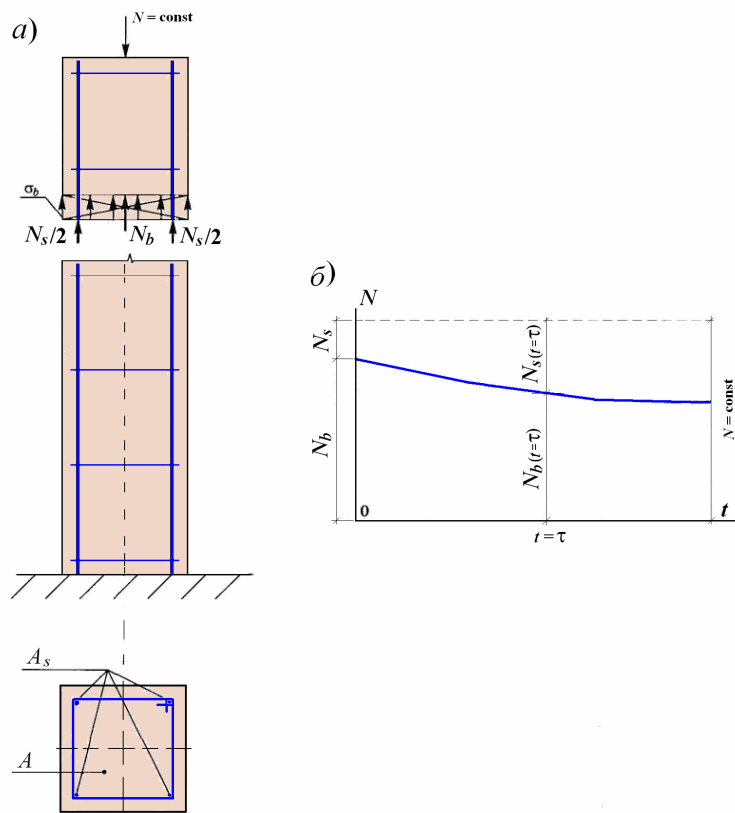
Перераспределение усилий между арматурой и бетоном в сжатой железобетонной призме вследствие ползучести бетона: а — схема работы железобетонной призмы под нагрузкой; б — характер изменения усилий в бетоне и арматуре при постоянной нагрузке в течение длительного времени
